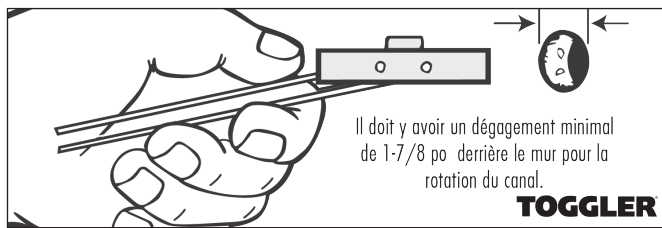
Installation d'un boulon à ailettes (ancrage mural).
